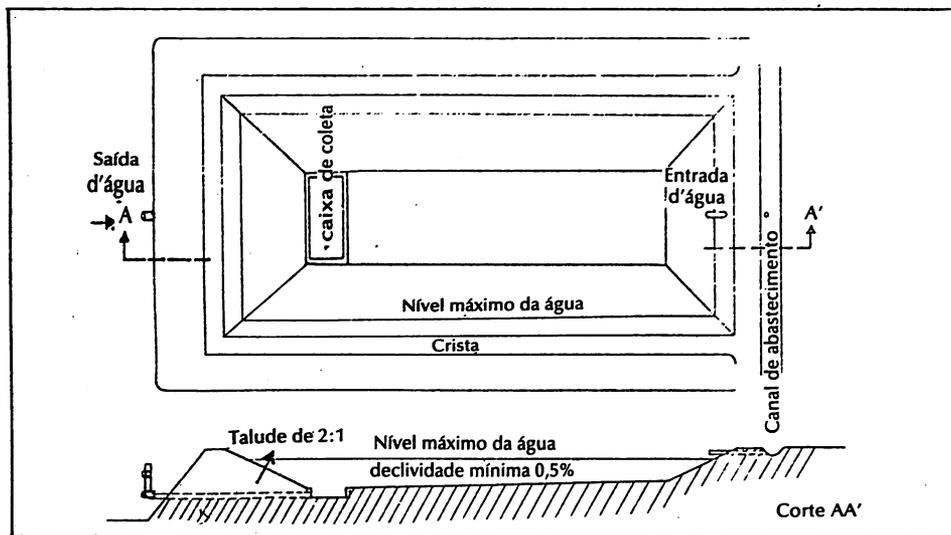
Planta baixa e corte de um viveiro com caixa de coleta, para facilidade de despesca.
